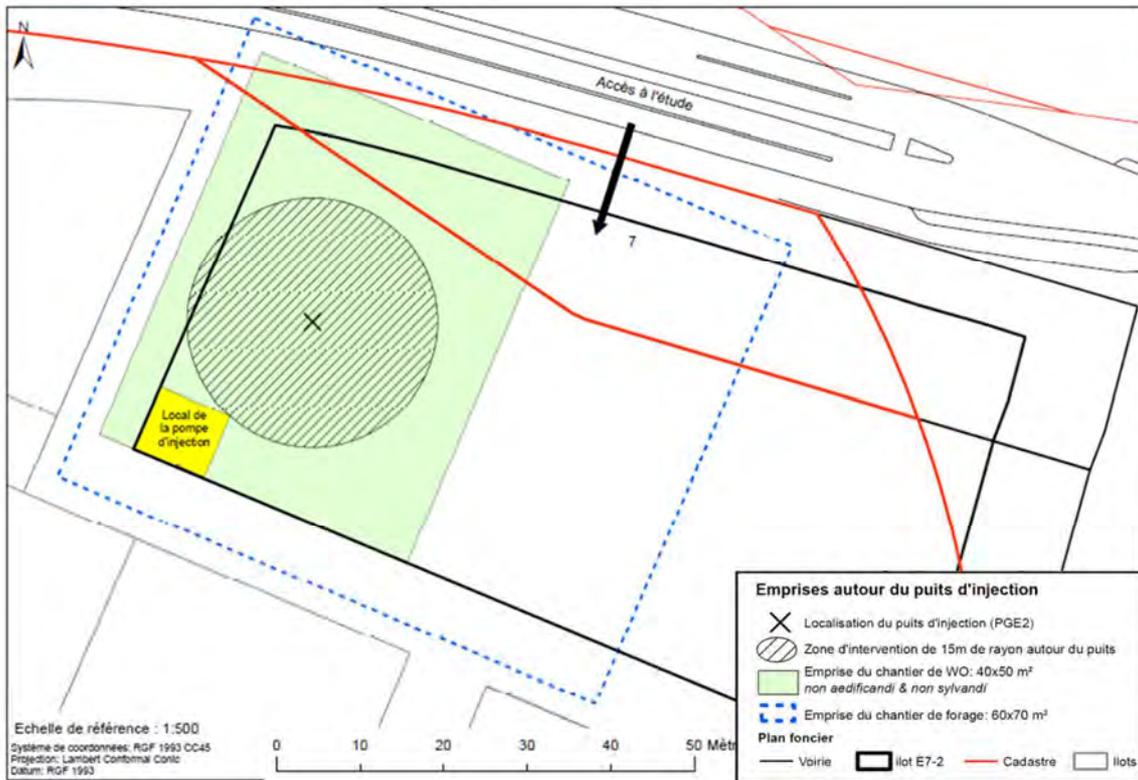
Emprise des travaux autour du puits PGE2 lors du chantier de forage (source : Storengy)
